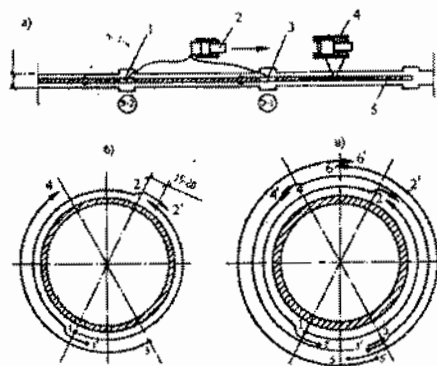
Пример карты трудовых процессов на сварку секций стальных труб в плеть: а - схема организации рабочего места; б - приемы труда электросварщиков при сварке корневого слоя шва; в - то же, при сварке среднего и облицовочного слоя шва; 1,3 - предыдущий и последующий стыки; 2 - сварочная установка УС-21; 4 - кран-трубоукладчик; 5 - трубопровод; Э-1, Э-2 - места электросварщиков, стрелкой указано направление работ
